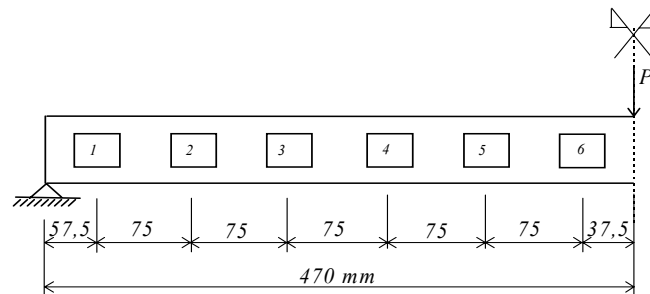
Posições das aberturas para metade da viga biapoçada (adaptado da referência 57).
